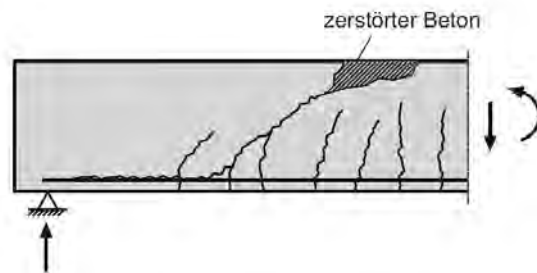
Biegeschubversagen ohne Schubbewehrung [31]
